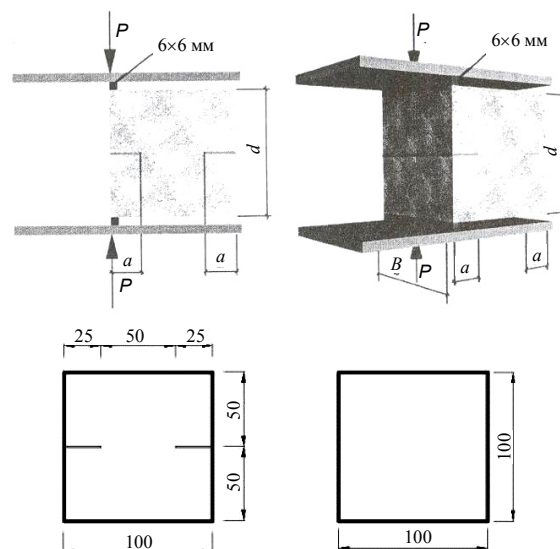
Образец с инициаторами трещины и схемой нагружения
